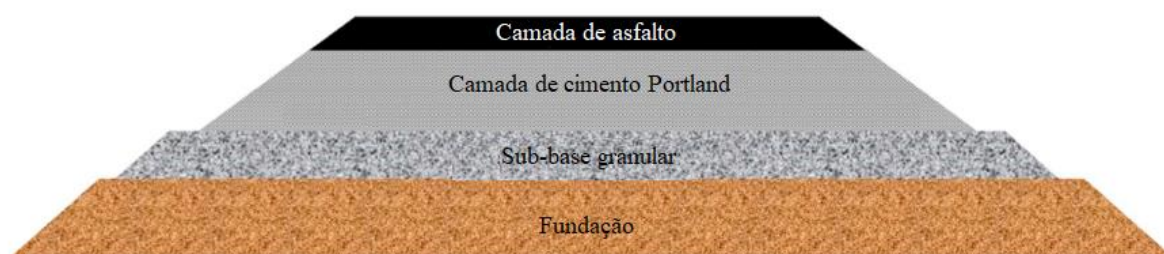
Seção transversal usual de um pavimento semi-rígido
